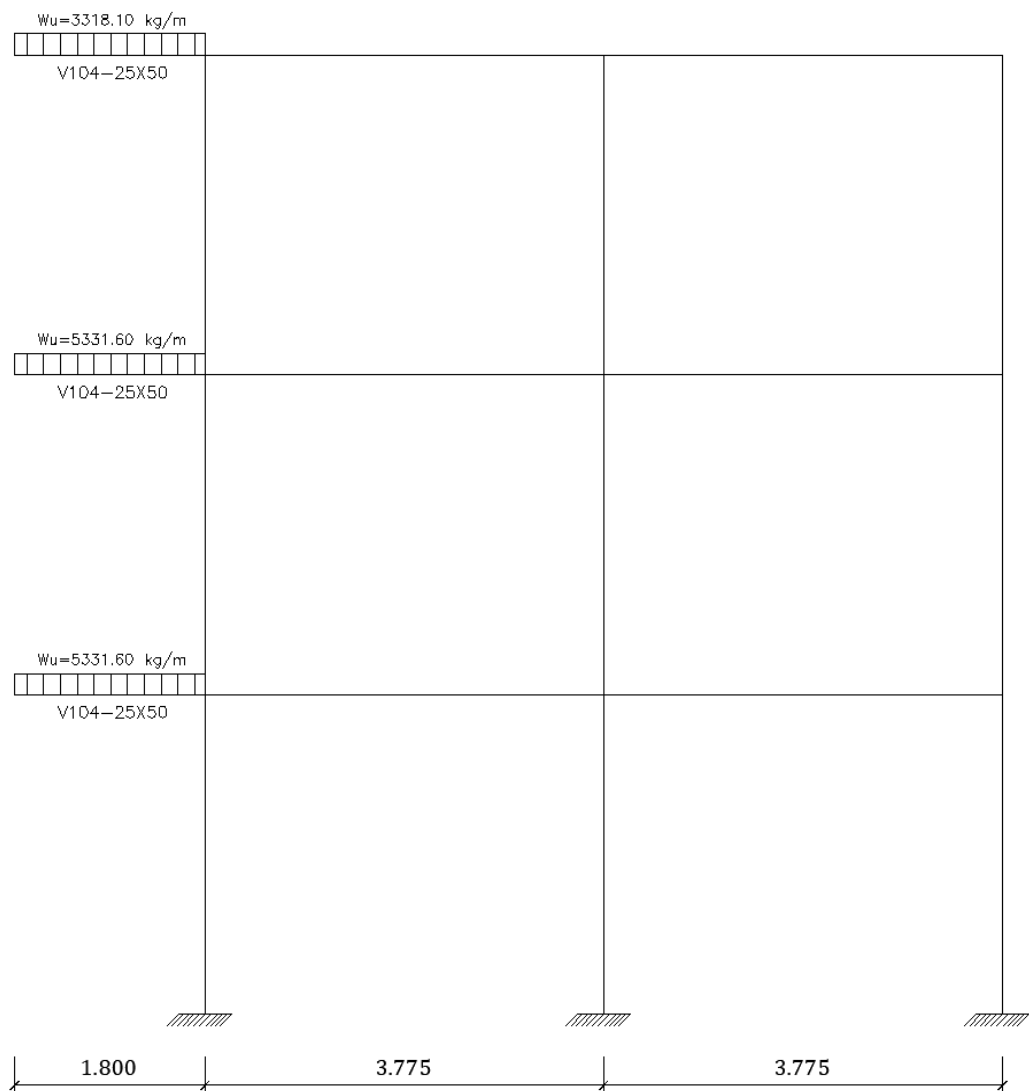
Distribución de cargas últimas en la viga V104-25x50
